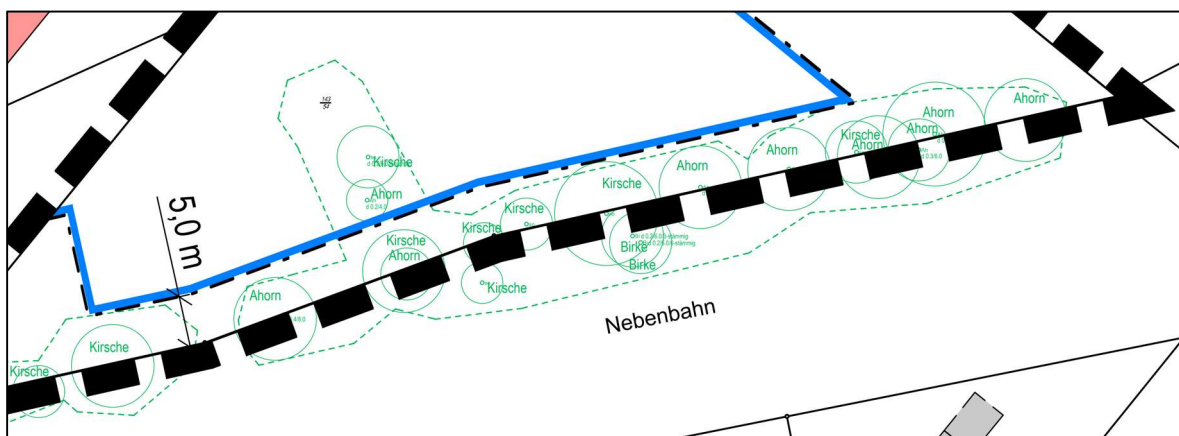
Auszug aus dem Bestandsplan (ÖbVI Mittelstädt & Trau) inkl. vorgesehener Baugrenze
